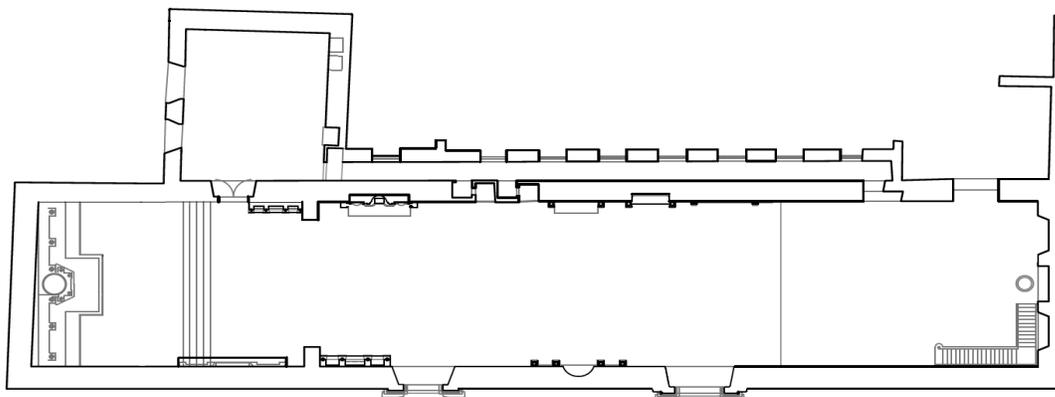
Plano del Museo Santa Clara. Fuente © Archivo Museo Santa Clara y Colonial.
